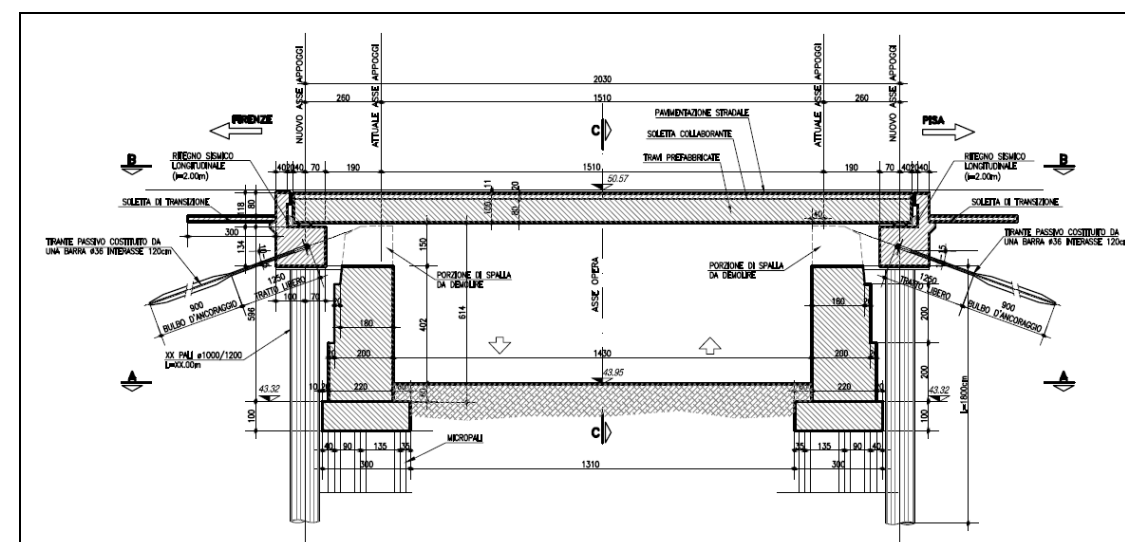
Sottovia di svincolo Prato est. Sezione longitudinale
